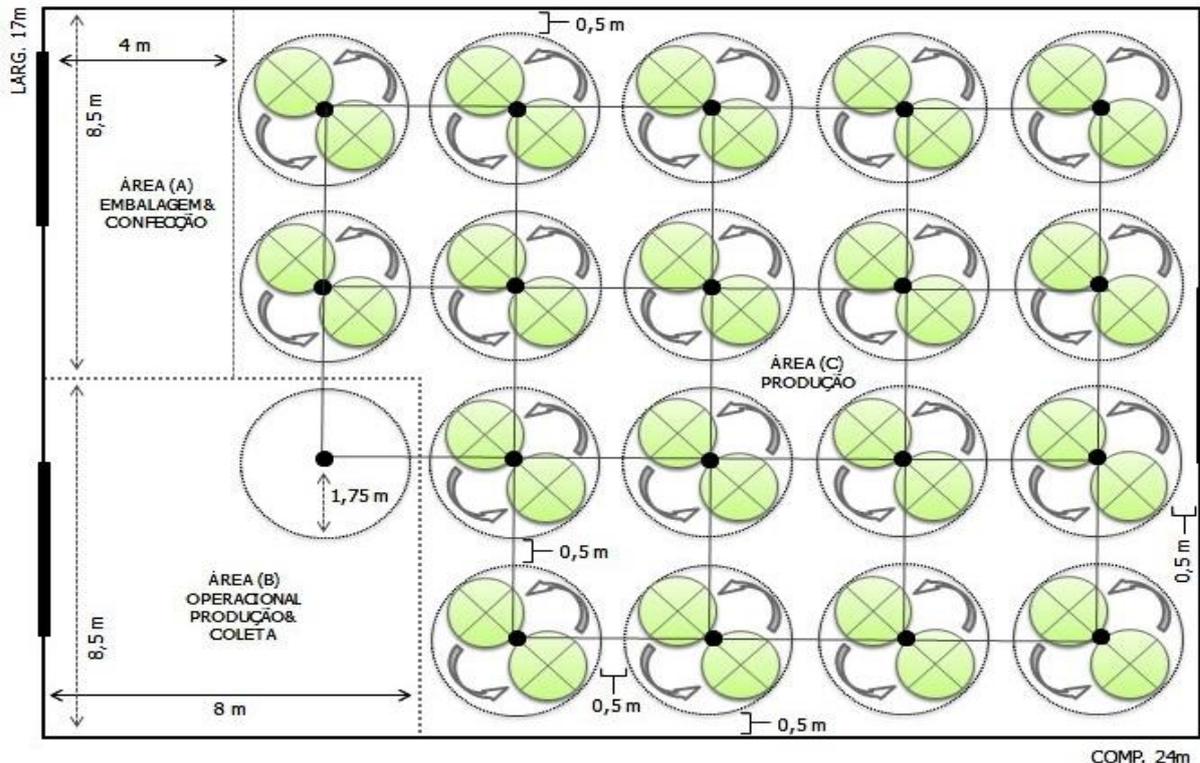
Planta de produção agroindustrial da Fazenda Vertical em Vancouver
